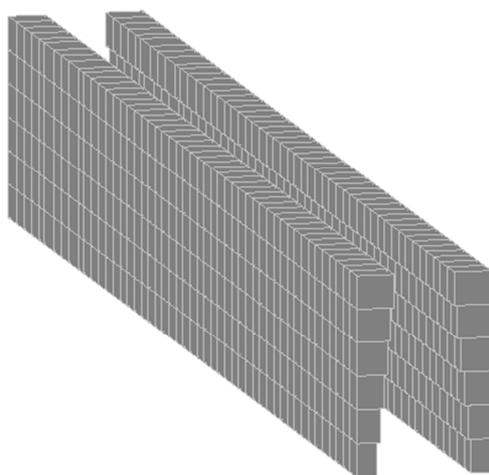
Продольные ребра железобетонной балки ростверка с разными жесткостями
